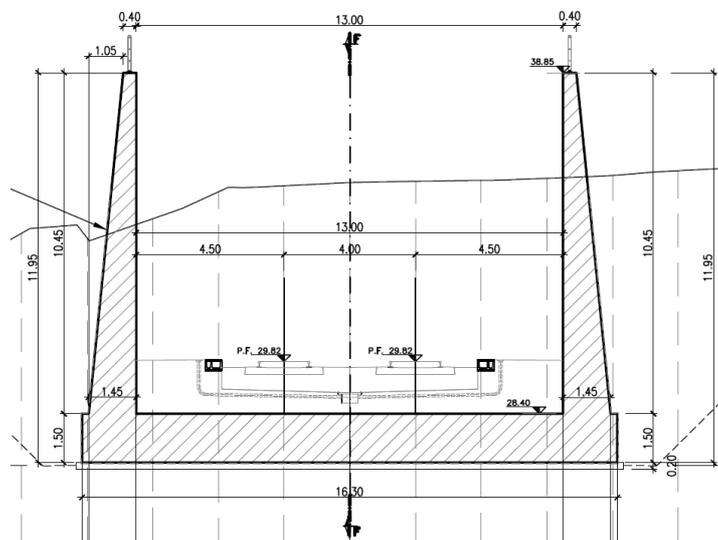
Sezione muro di imbocco (Hmax=10.55 m)
